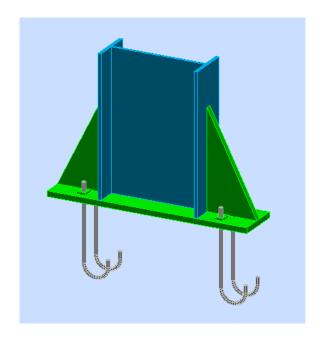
Vue en 3D d'assemblage pied de poteau.
